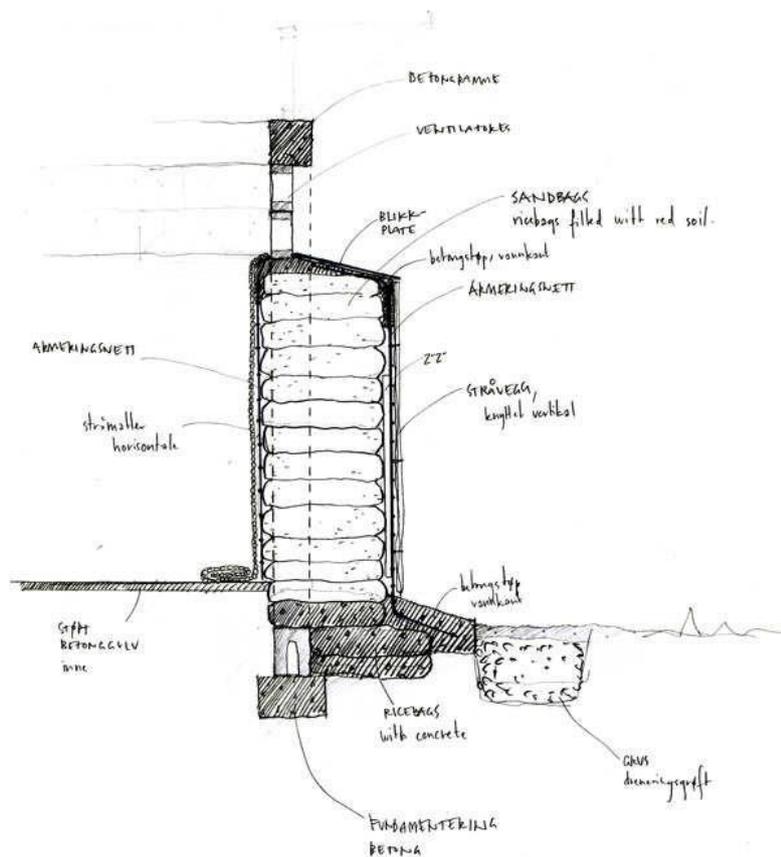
Promenor construtivo de parede com estrutura em betão e enchimento de terra. Centro Polivalente de Chimundo. (ArchDaily. [Em Linha] [Consult. 05 de Junho 2015.] Disponível em <http://www.archdaily.com/144527/educational-building-in-mozambique-andre-fontes-sixten-rahlff/>)
